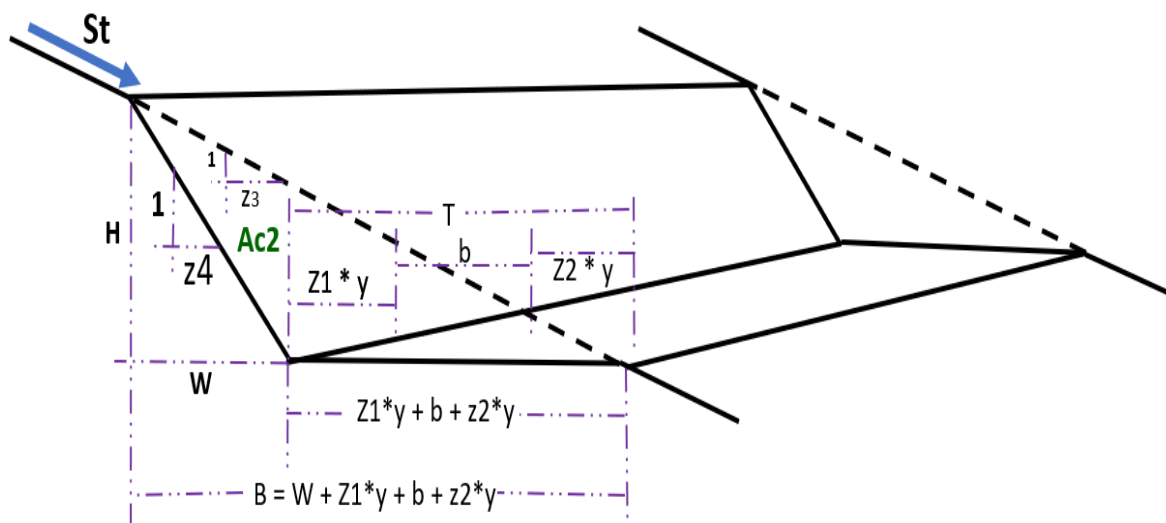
Área de corte 2 “Ac2” para una acequia de ladera trapezoidal
